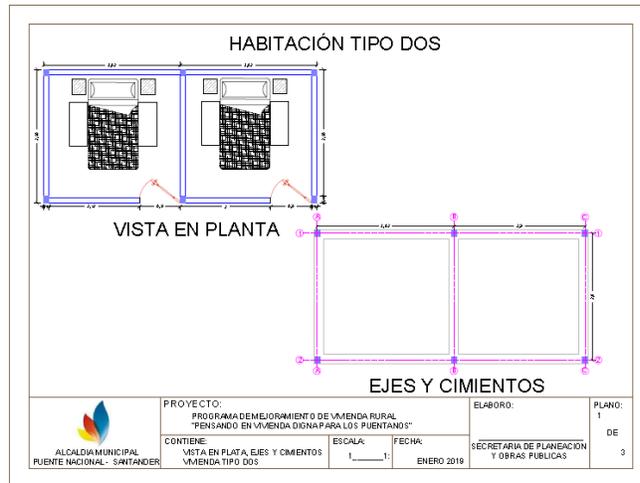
Vista en planta, ejes y cimentaciones de las habitaciones
